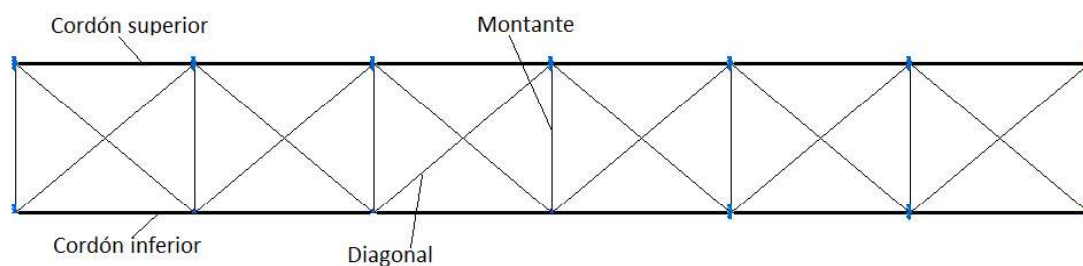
Viga de Contraviento tipo Pratt de cubierta
